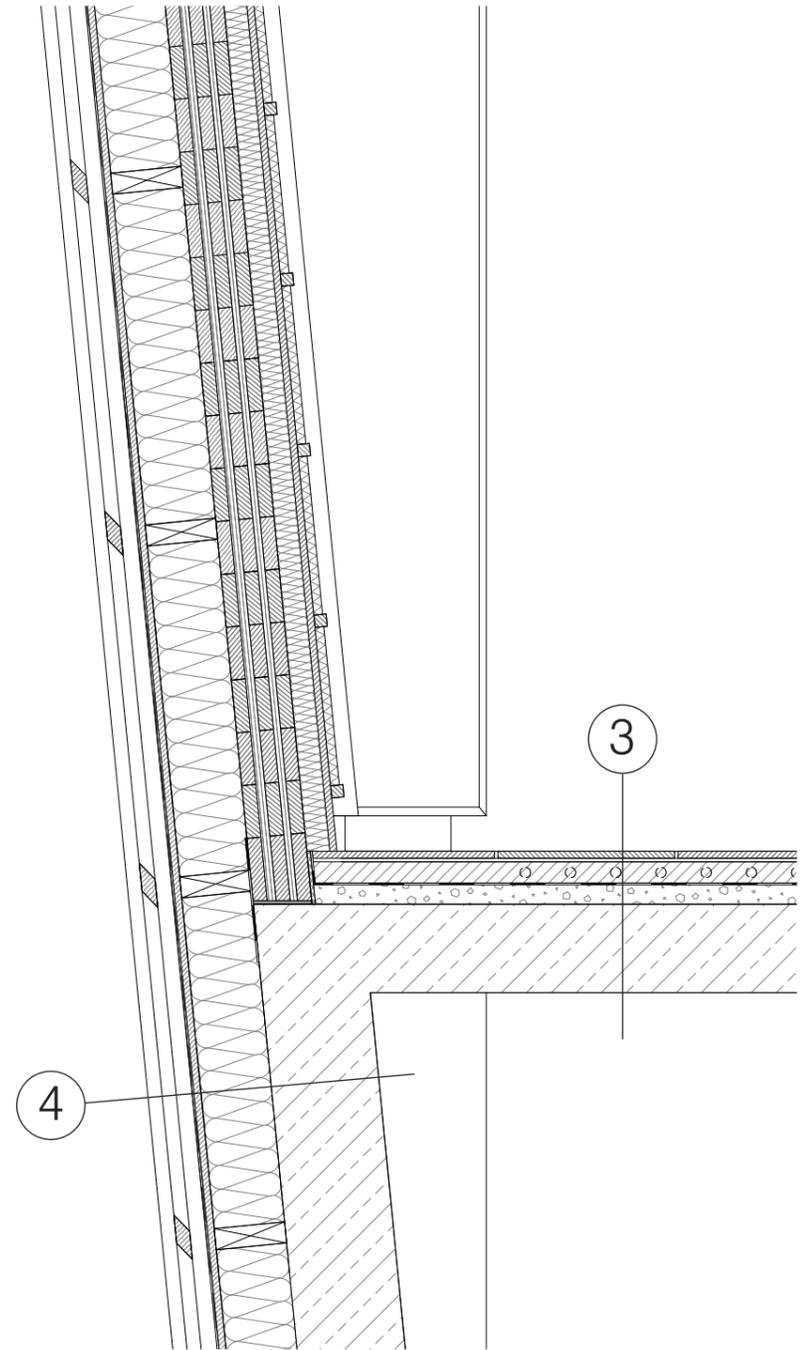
Fassadenschnitt 1 Deckenanschluss 1:20
